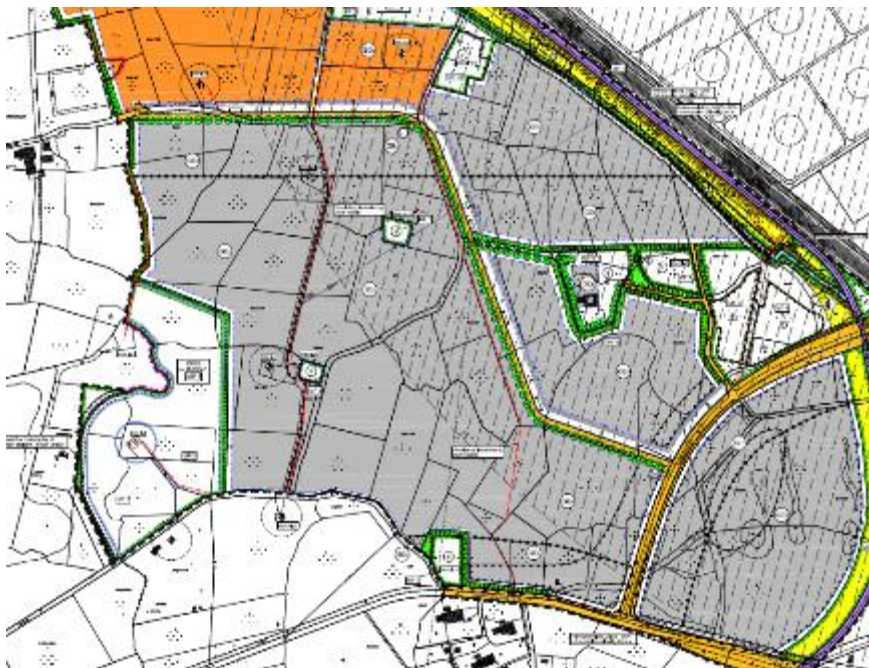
Auszug Bebauungsplan Nr. 191 Bauens / Memershausen (RK 30.01.2010) (Quelle: Stadt Wilhelmshaven 2023)
